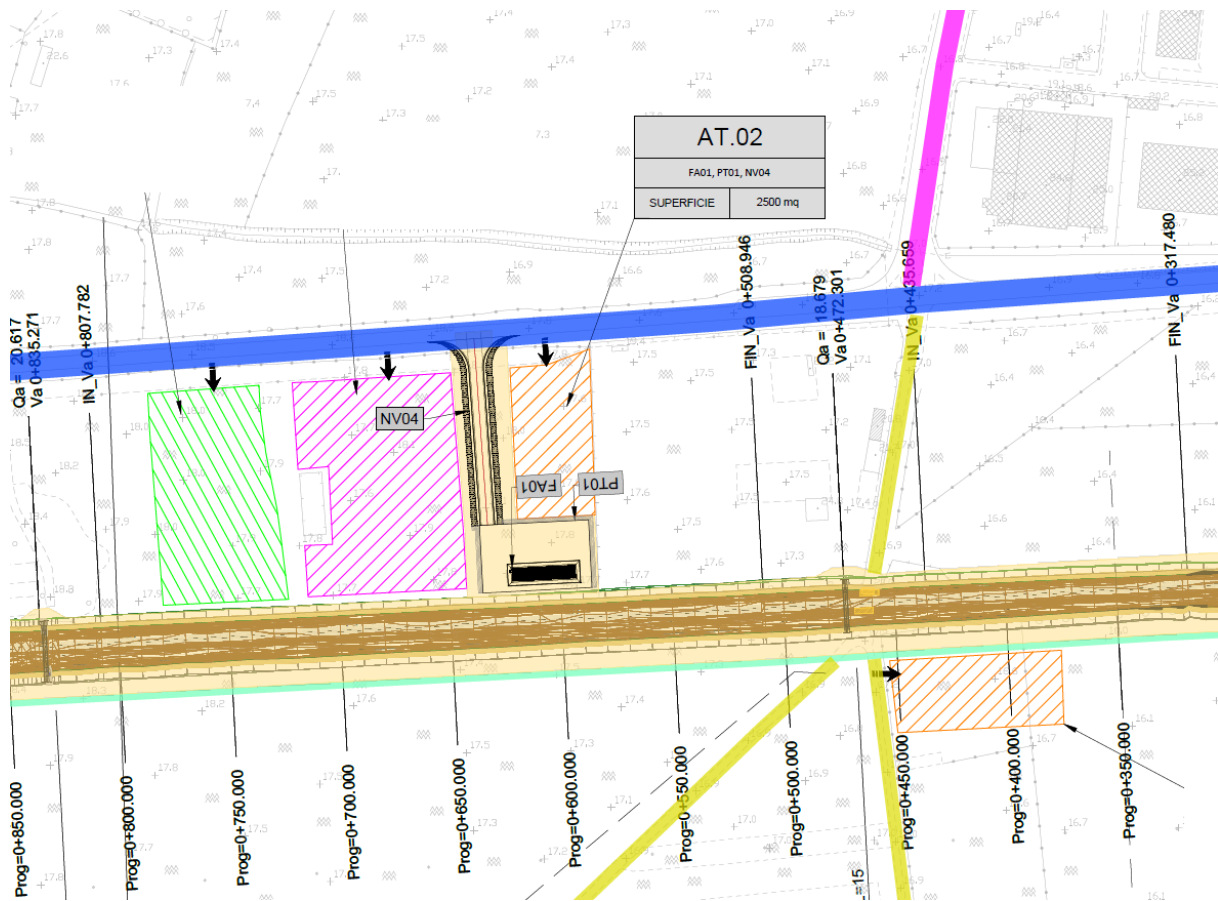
Vista in pianta dell'area di cantiere AT.02
